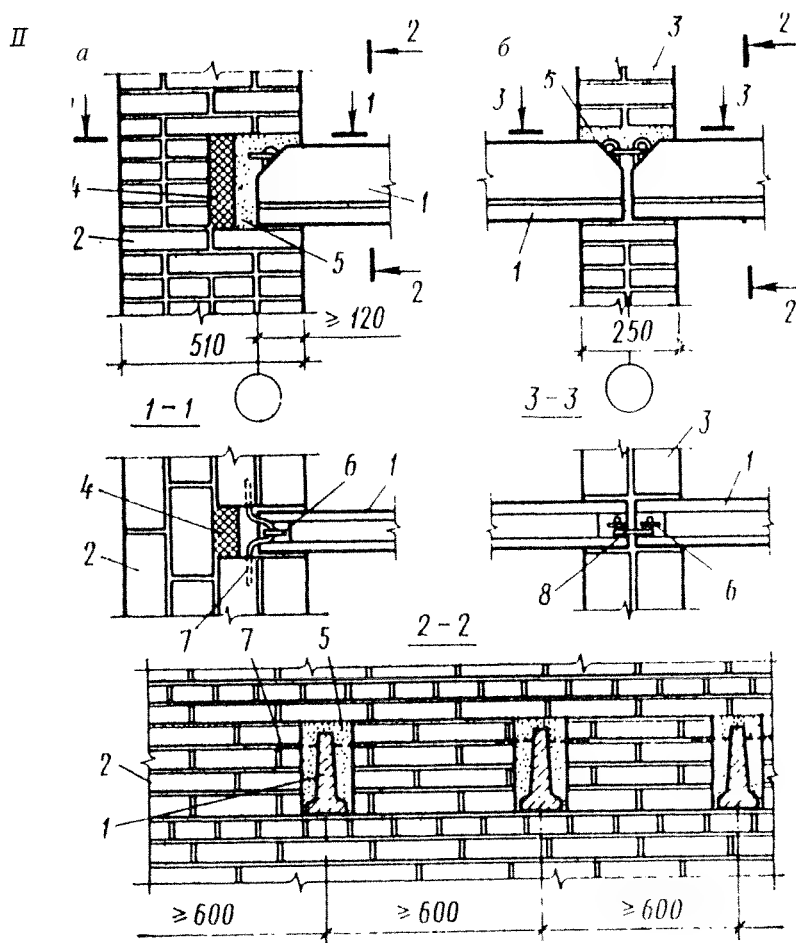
Опирание балок перекрытий на каменные стены:
